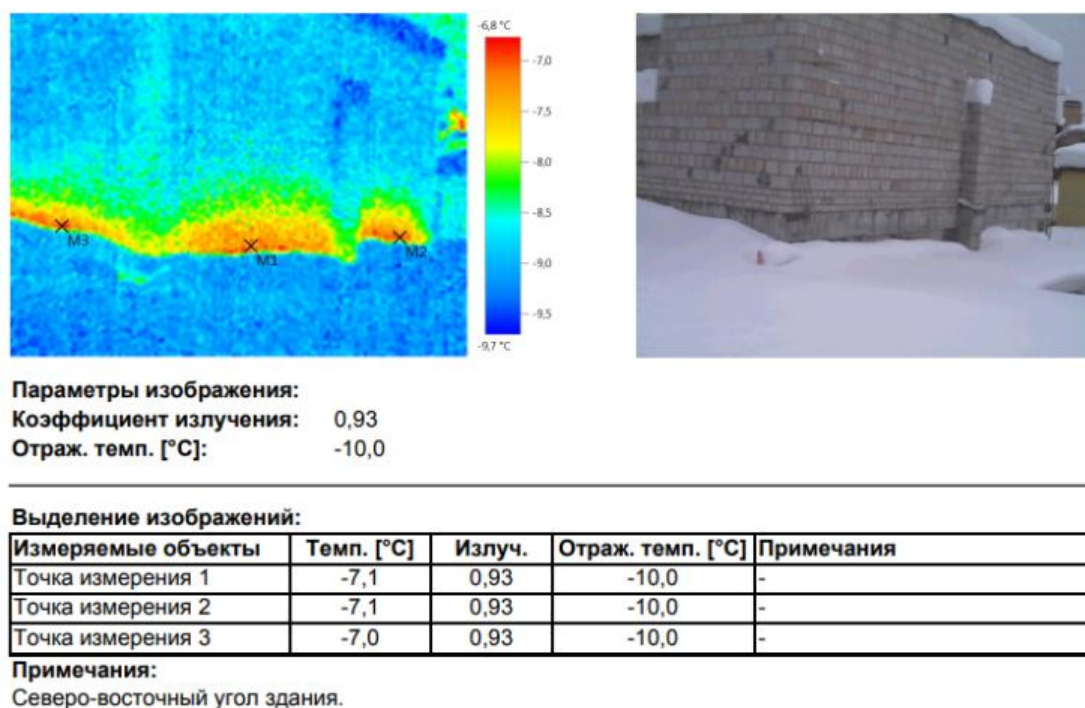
Температурные поля на наружной поверхности фундамента здания
